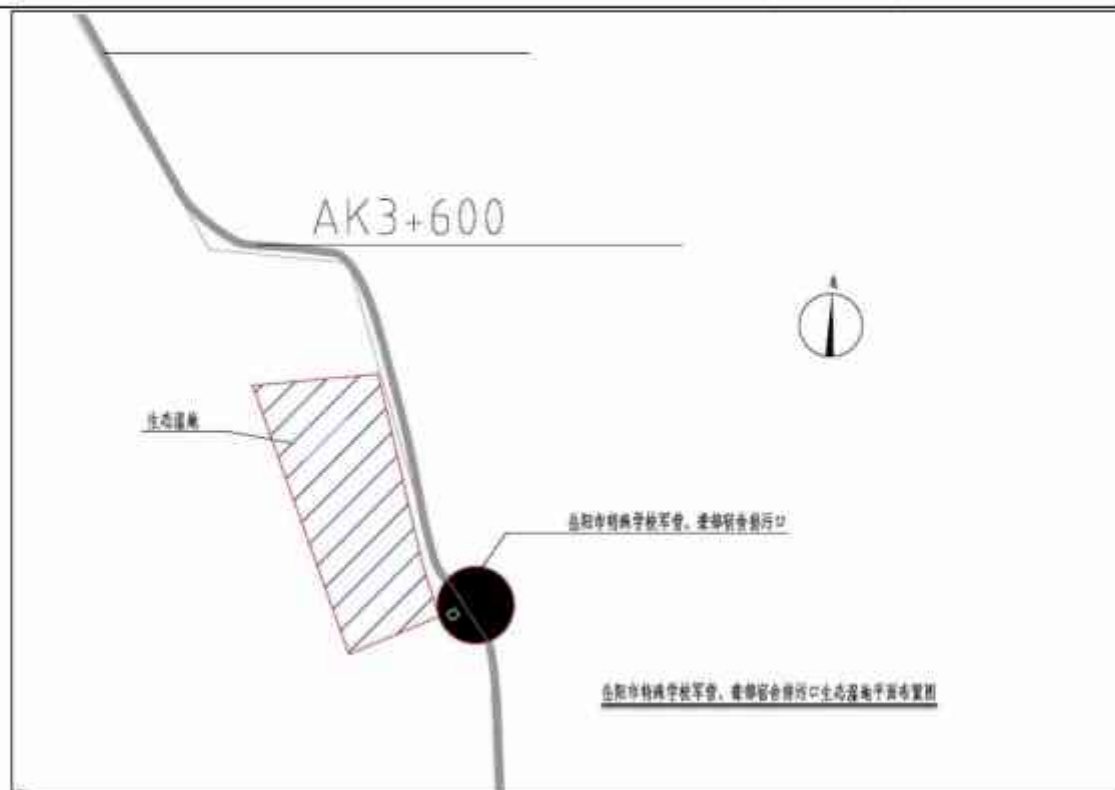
排污口平面布置图一（特殊教育学校排口）
